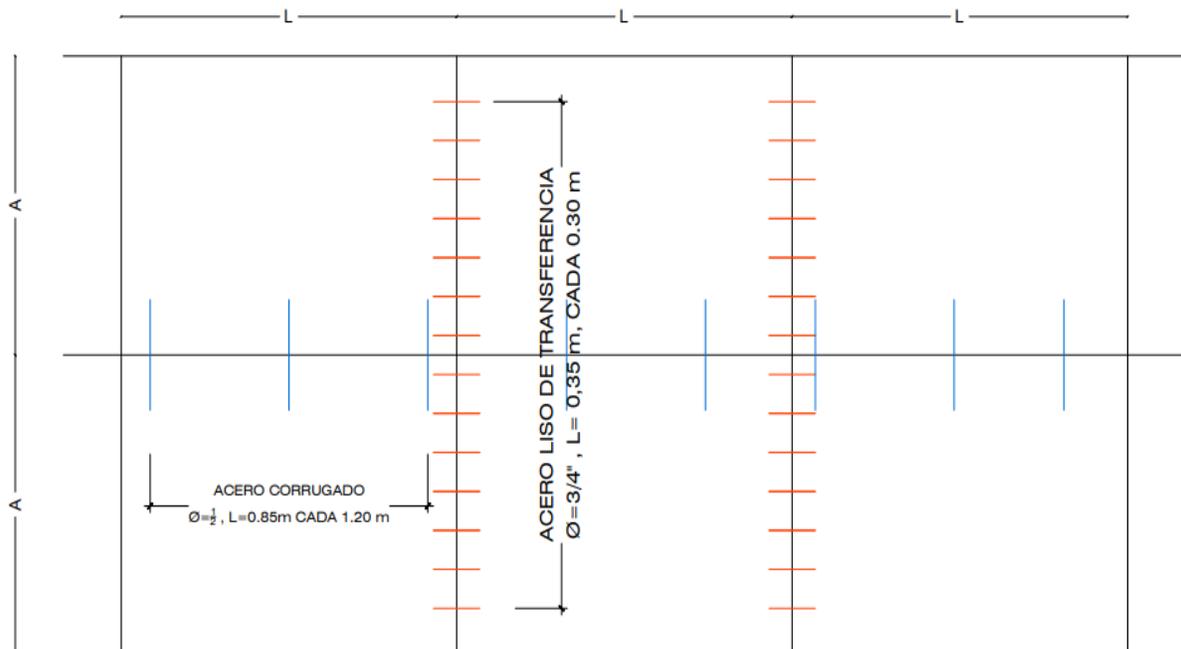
Detalle de dimensiones y aceros en pavimento rígido. Fuente: AMO, 2019.
